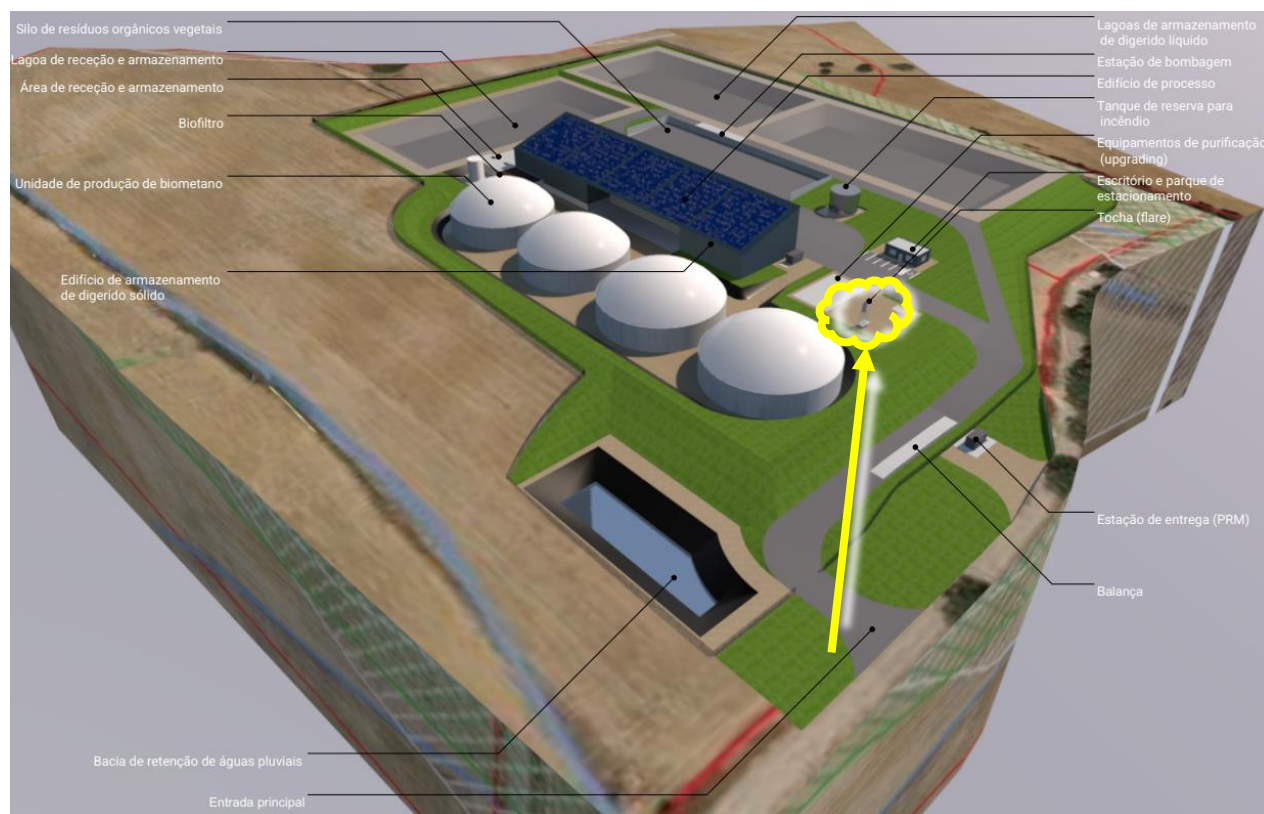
Plant Overview with the Flare highlighting / Visão geral da planta com destaque para a chama
